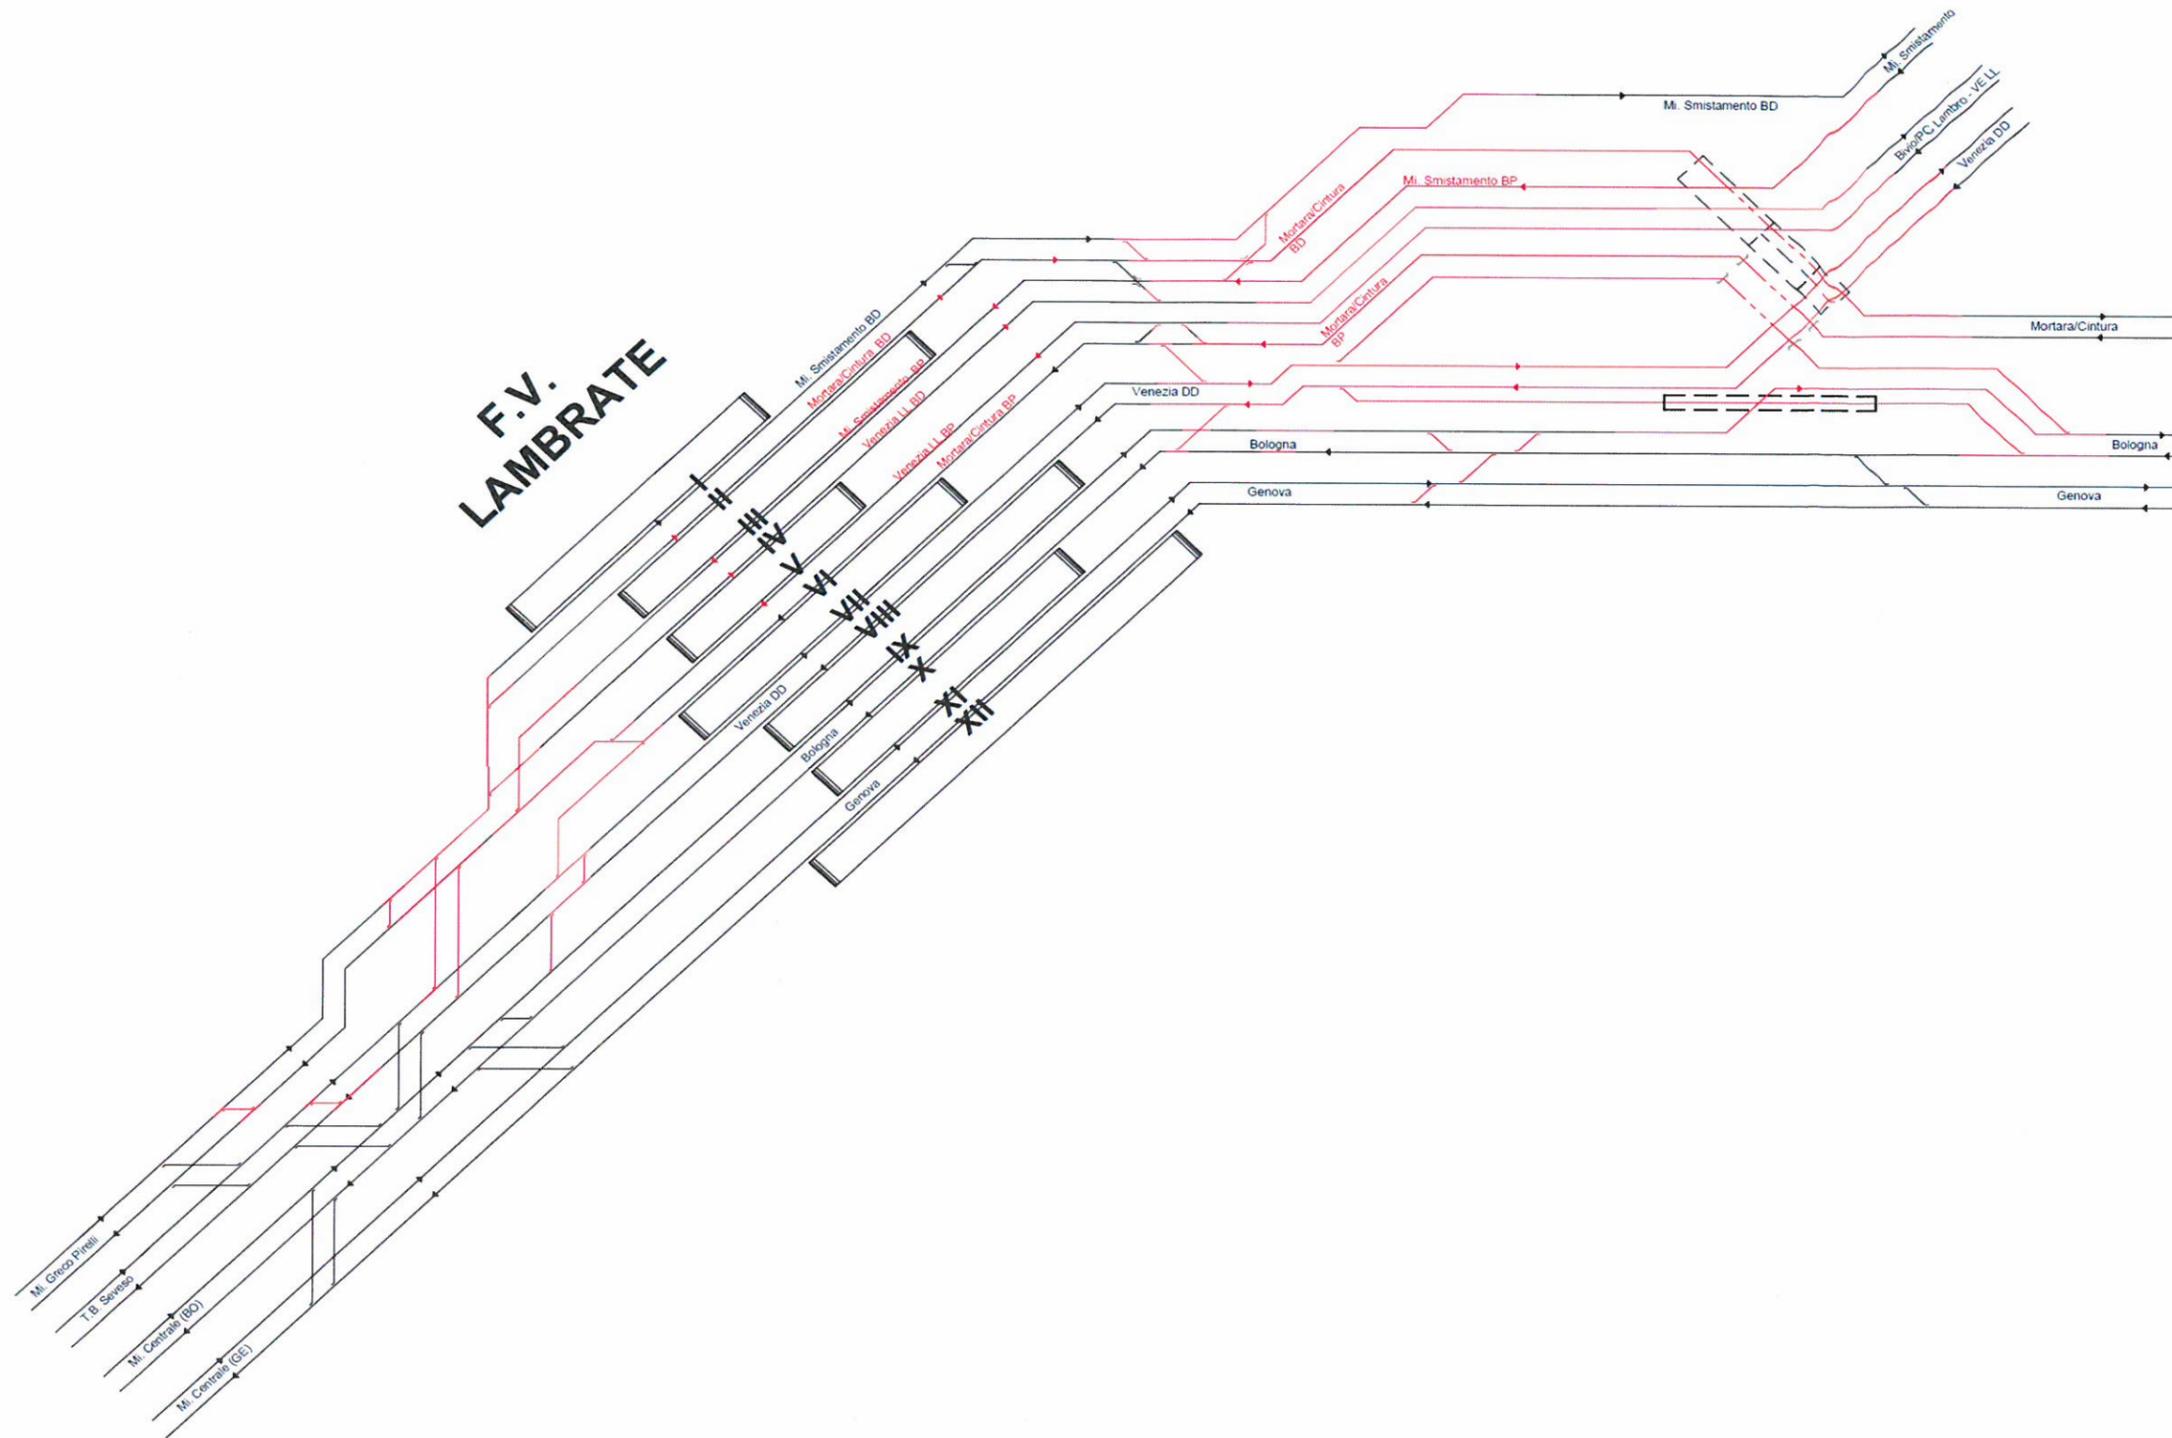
key-plan degli interventi nella stazione di Milano Lambrate
